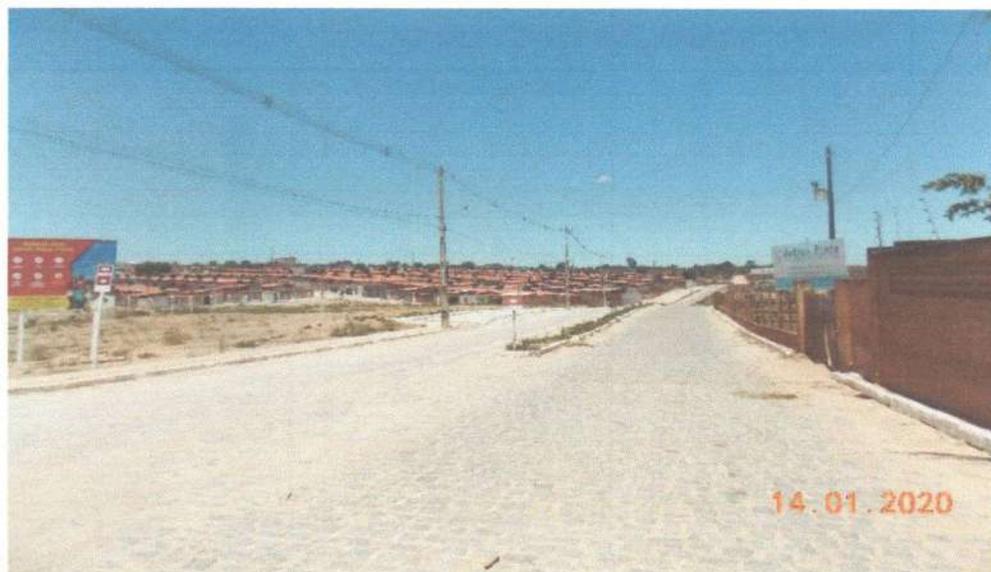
Via principal de acesso Bairro Dom Hélder Câmara (Loteamento São Vicente). FONTE: Aluisio Sales, 2020.
